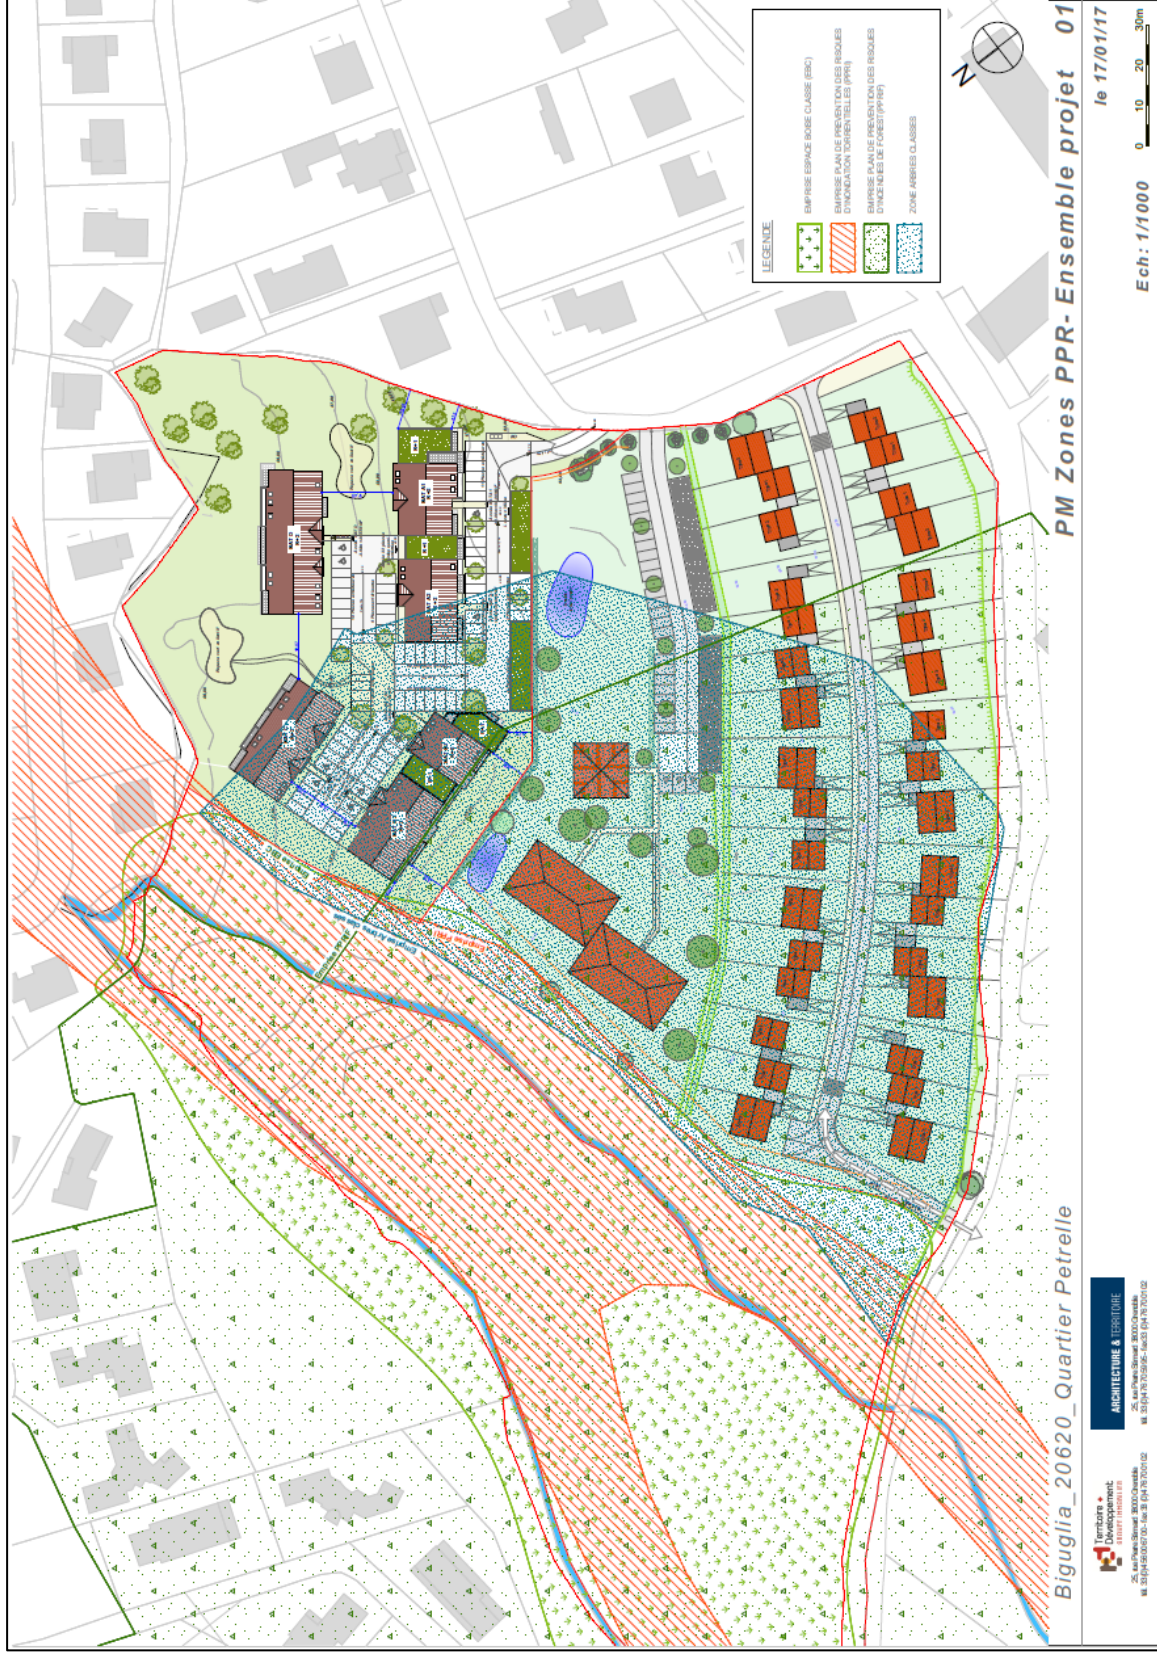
Plan de masse projet Petrelle – janvier 2017 (T&D)
